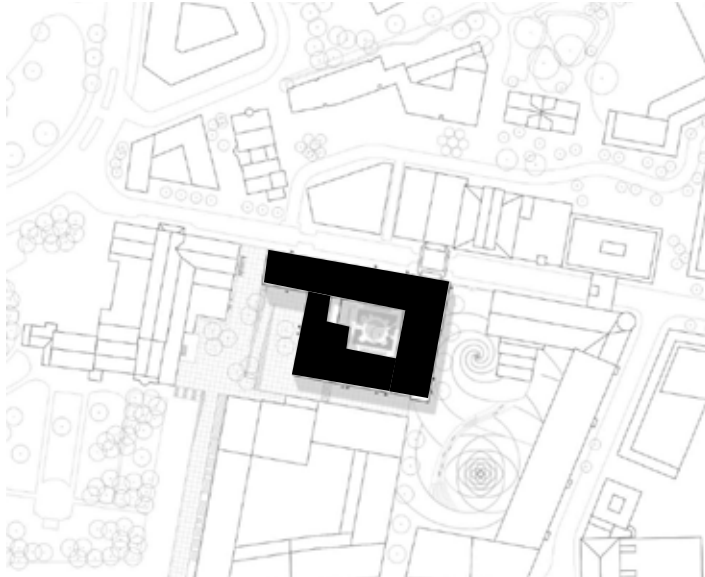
Lageplan, Quelle: ADEPT, Kopenhagen
